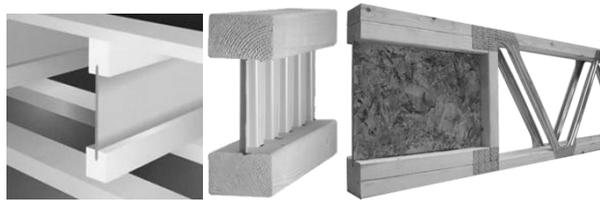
Tipos de viga prefabricadas, viga TJI de sección constante, viga Nailweb de acero y madera, viga Spacejoist abierta de madera y acero⁷⁻⁸⁻⁹
